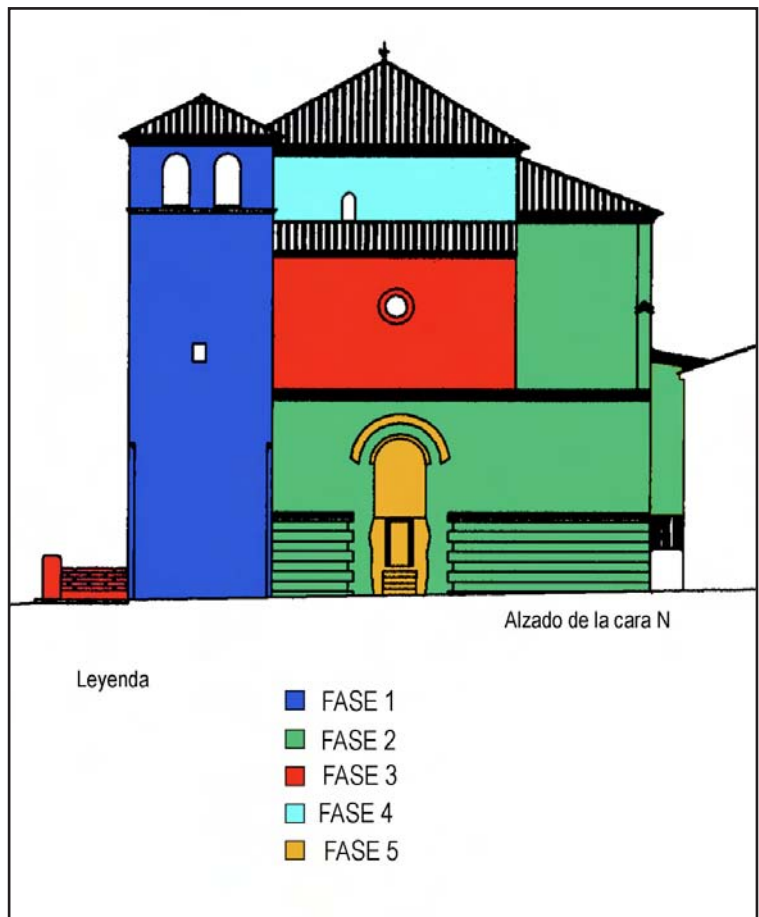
Fases en el alzado de la cara N de San Miguel (incluye estructuras demolidas)
